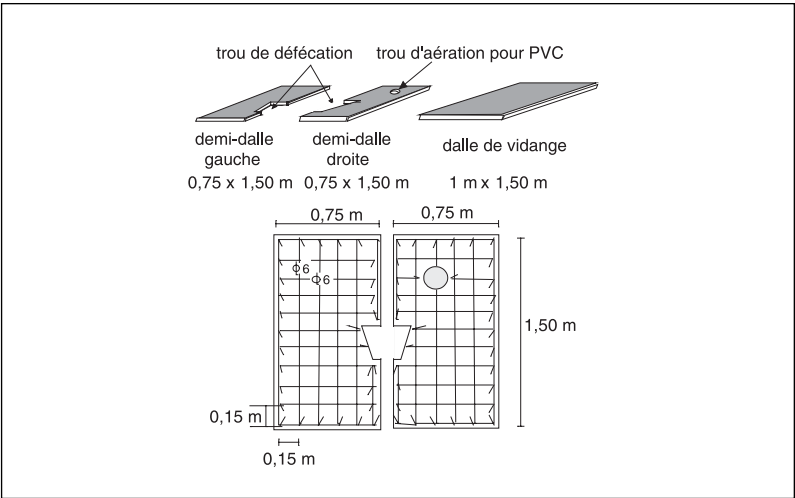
Armatures d'une dalle en deux parties symétriques.
